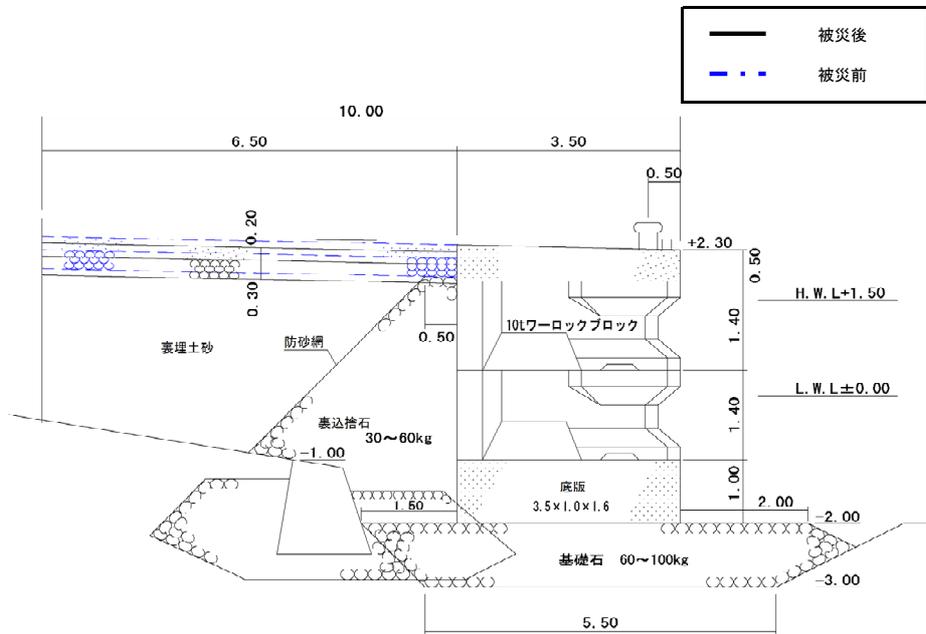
No.24 大洗港区_第1埠頭 C 物揚場 (-2.0m) の断面図 (被災後)
